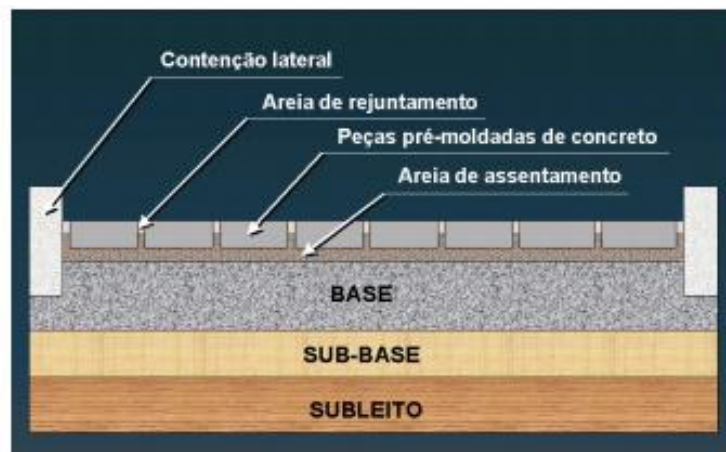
Estrutura de pavimento de blocos de Pavês. (Hallack, 1998).
